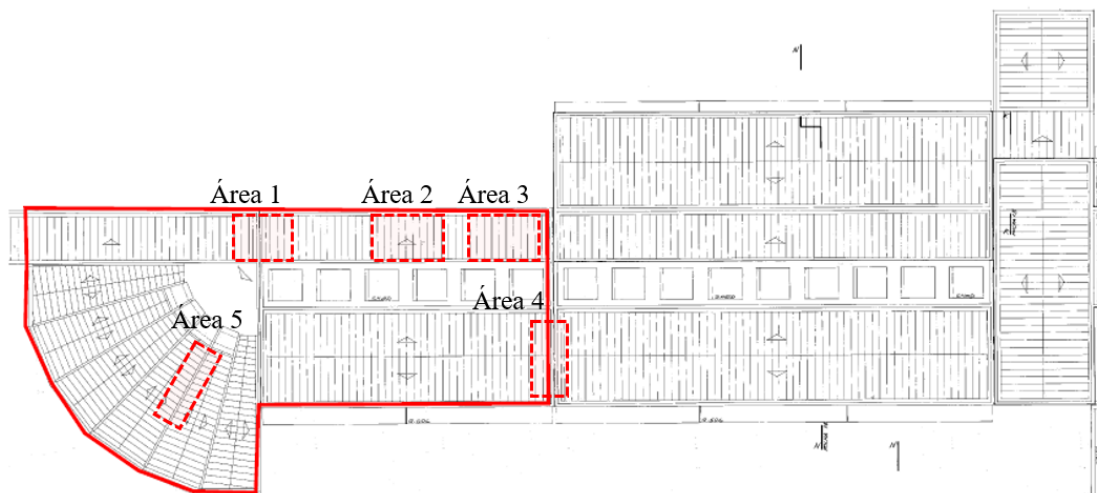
Destaque en el plan de situación para el área construida (Adaptado de CEPLAN, 1973).
